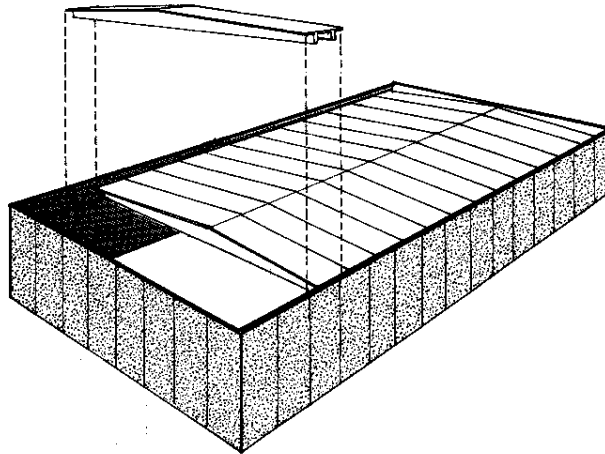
Schematische voorstelling van een grote open hal met dragende gevels en zadeldak
